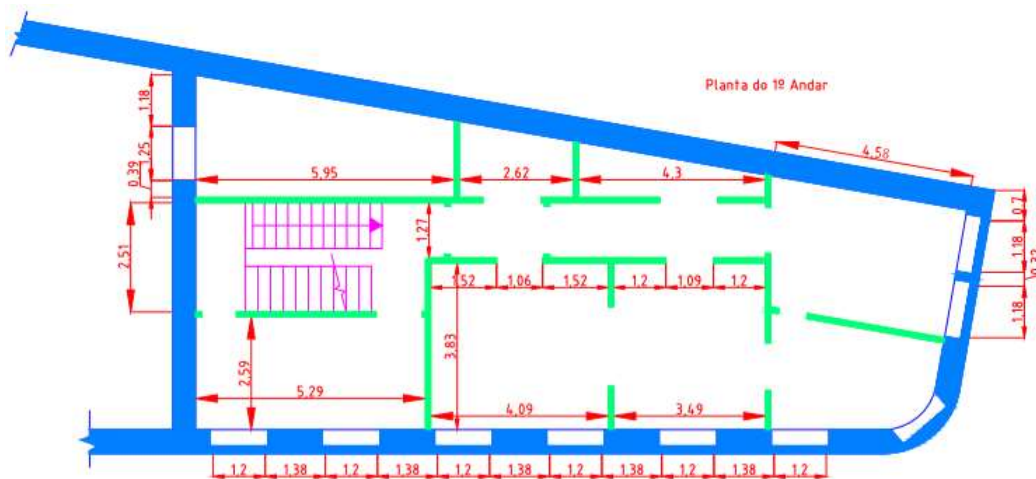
Planta Arquitetura atualizada do primeiro Andar
